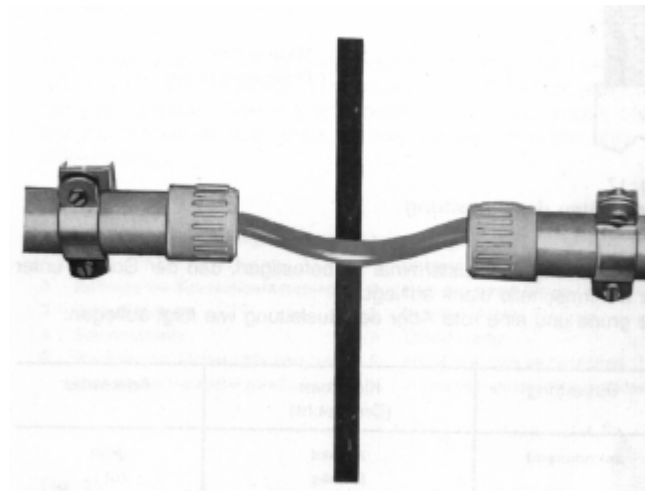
Interruzione del tubo di protezione su un giunto di dilatazione
